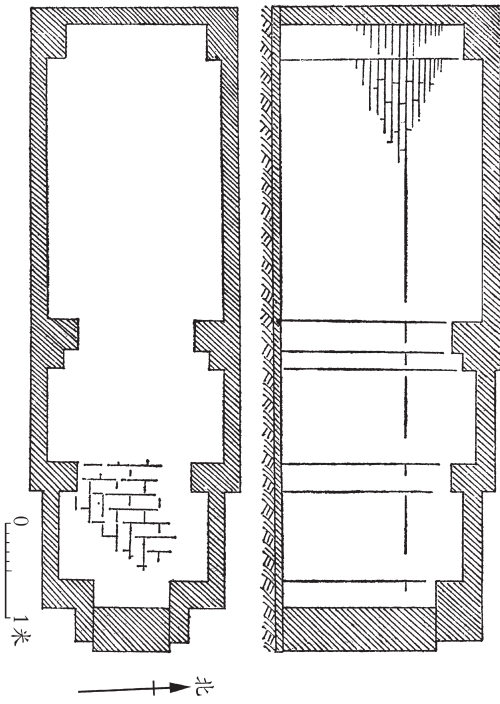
江西省靖安虎山 M1 平·断面图 (1/80)
